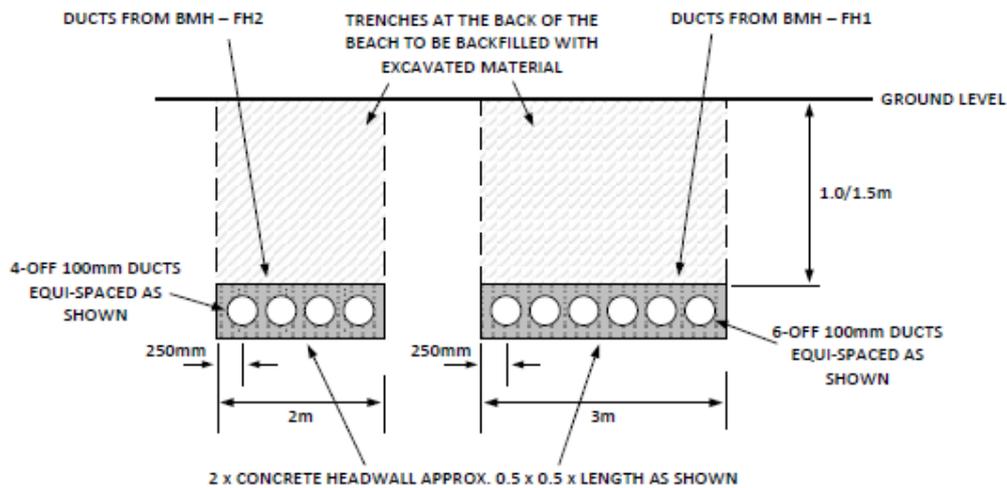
Schema dei blocchi di ancoraggio “head walls”
